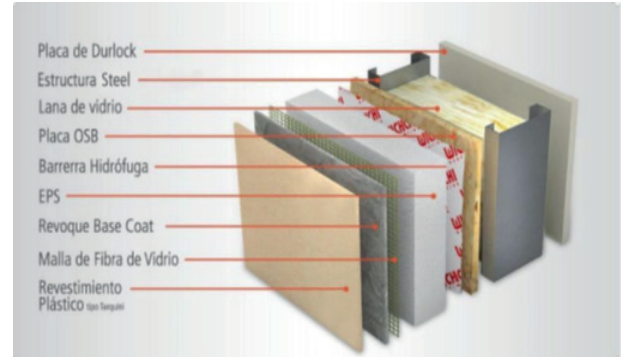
Detalle ideal de un muro construido en base al sistema Steel framing.
